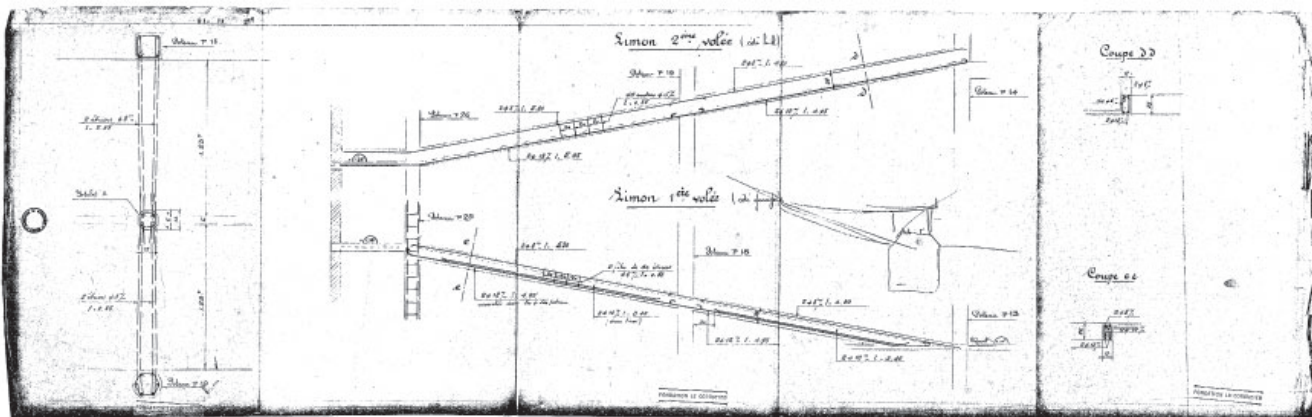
Sección de las zancas de la rampa en planta baja de la Villa Savoye, a escala 1:50, Cormier. FLC H1 (13) 299.
